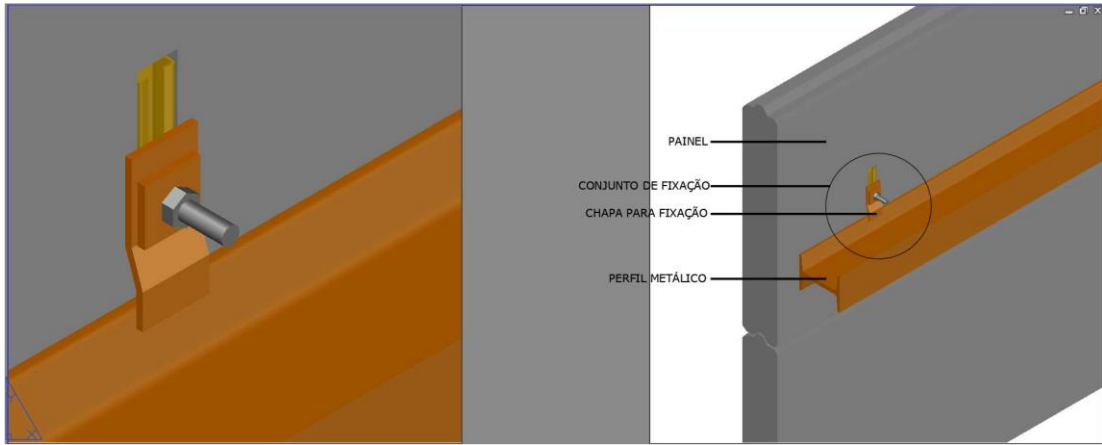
Pormenor de fixação de um painel pré-fabricado com um perfil metálico (José Rui Pinto, 2021)
